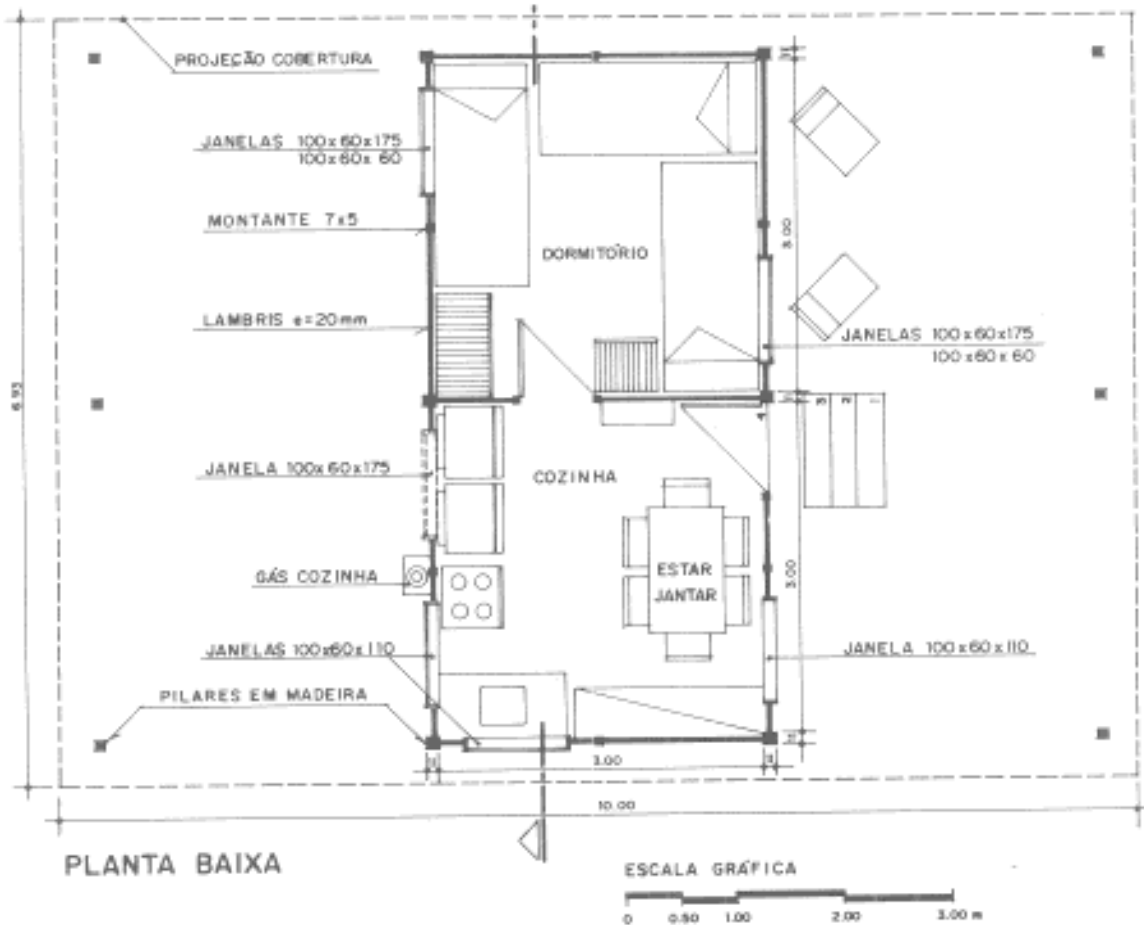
Módulo Rébio Rocas: planta baixa
